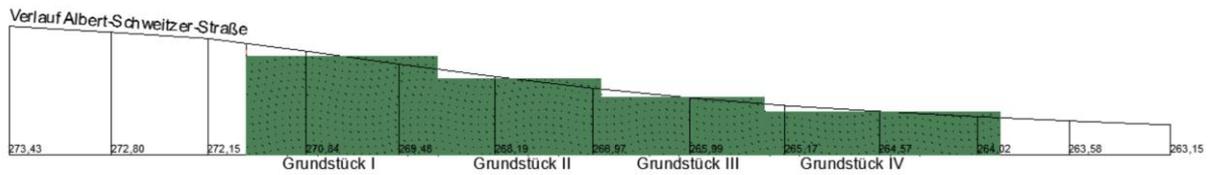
Straßenschnitt und angedachte Aufschüttung der Grundstücke
